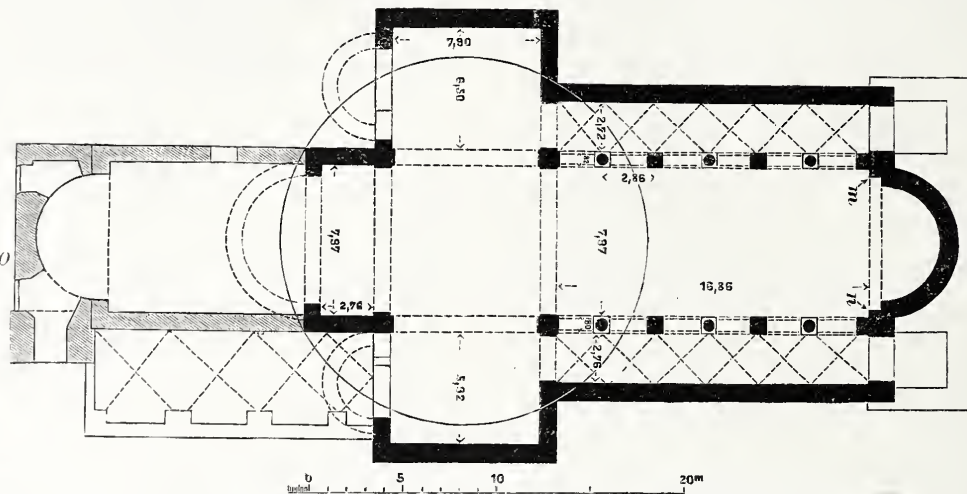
Klosterkirche auf Huyseburg. Grundriss.
